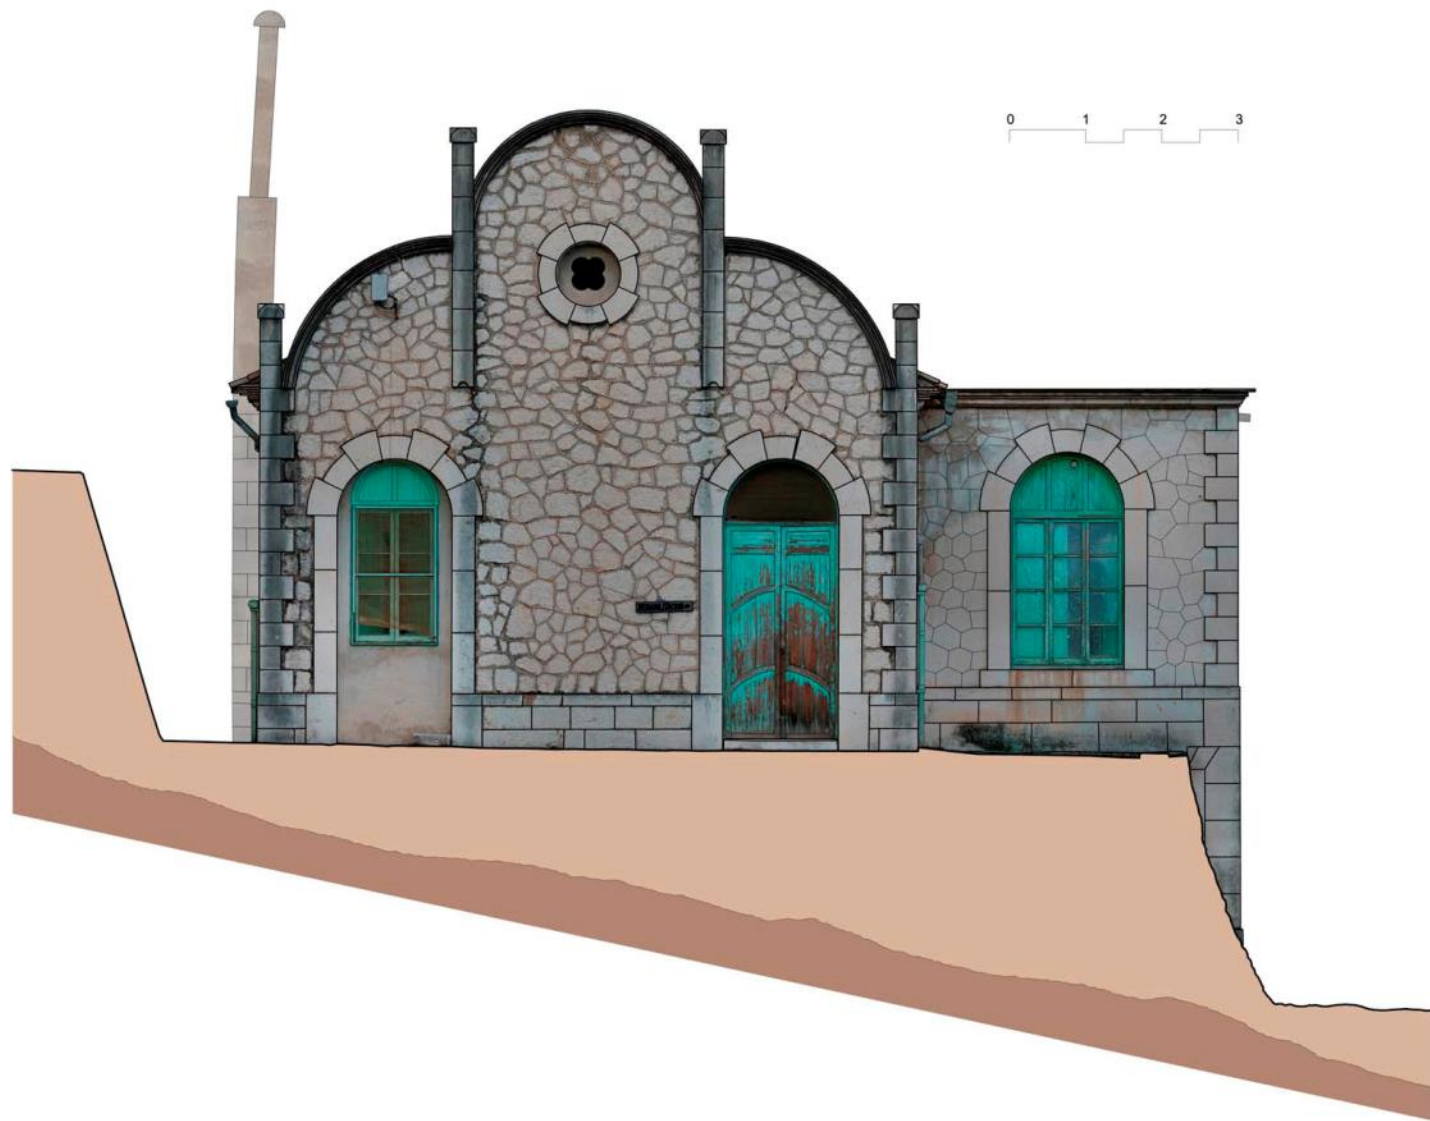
Alzado principal Sur. Fotoplano y Levantamiento planimétrico.
